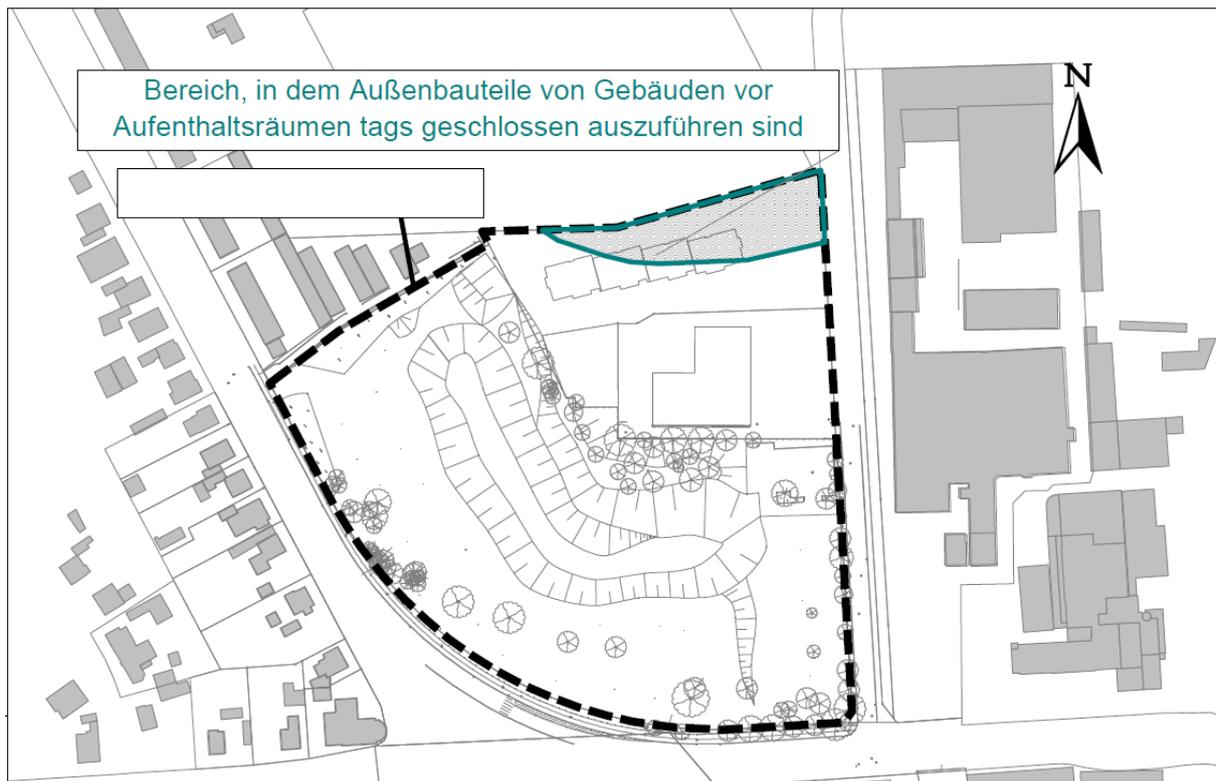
Lage des Bereiches, in dem Außenbauteile von Gebäuden vor Aufenthaltsräumen tags geschlossen auszuführen sind (s. Sportlärm)
